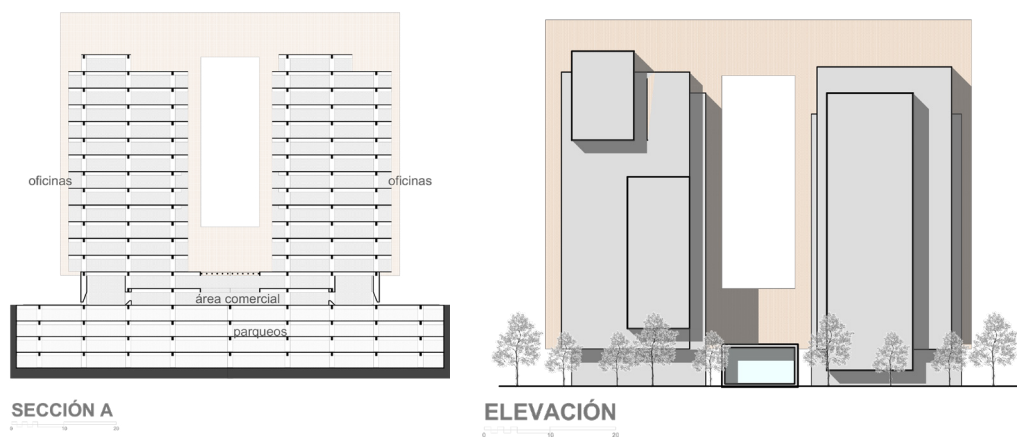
El sistema estructural portantes es el de marcos de concreto, columnas, vigas y losas.
